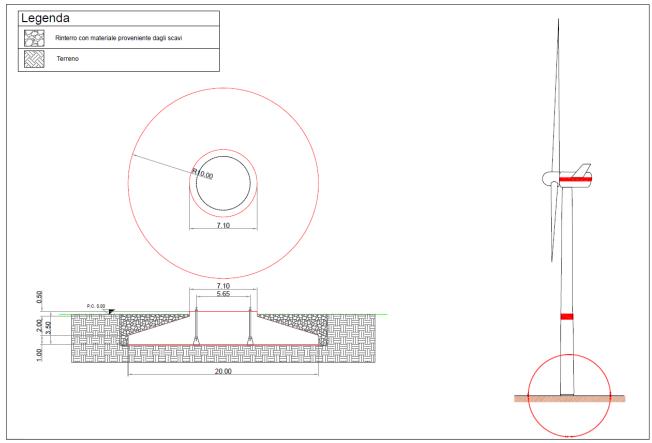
Fondazioni tipo per l'installazione degli aerogeneratori
